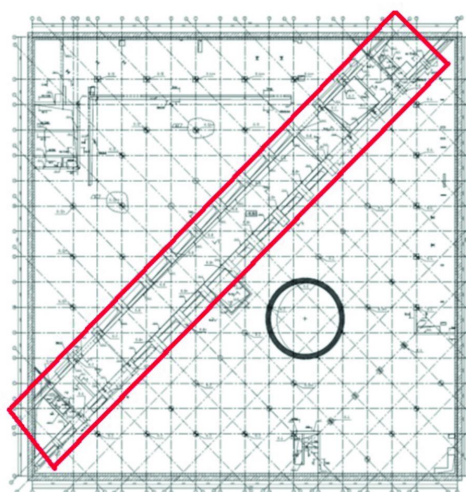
Скорректированное техническое решение проекта части конструктивной системы в зоне опирания стальных ферм на монолитные конструкции (план)
